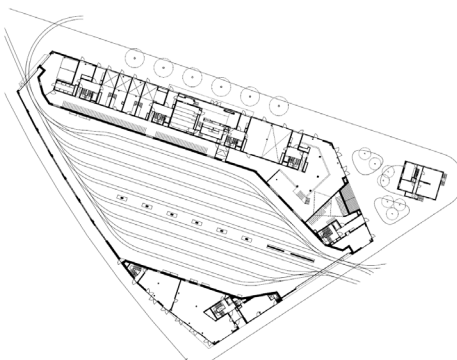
d Plan du rez de chaussée. Source: Müller Sigrist.
